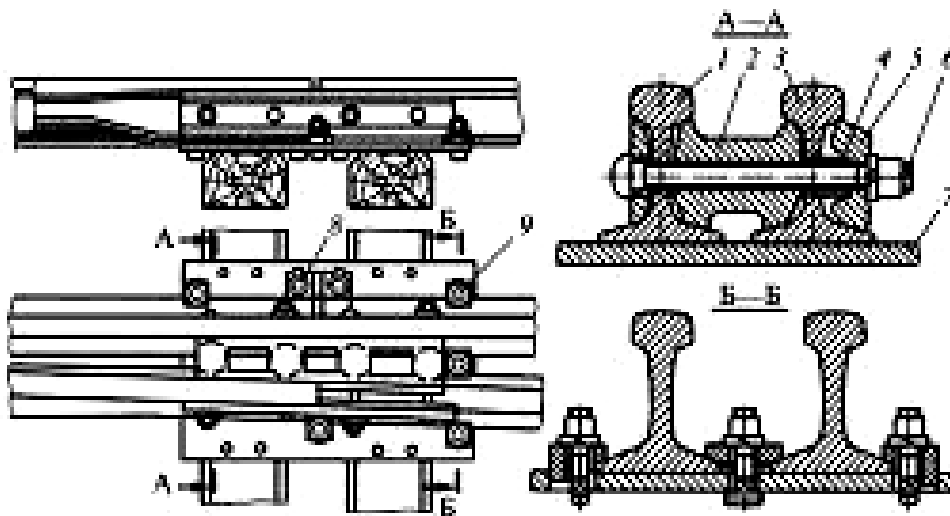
Кореневий пристрій вкладишно-накладочного типу:
